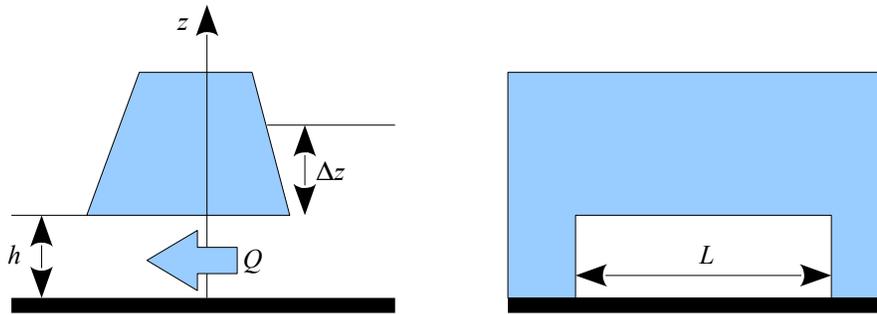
Passage sous un remblai routier. Gauche : vue en coupe. Droite : vue de face.
